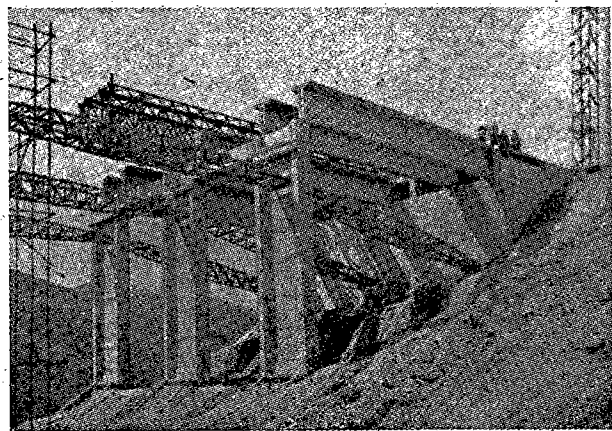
Předvyrobené Freyssinetovy klouby pro nosné stěny
